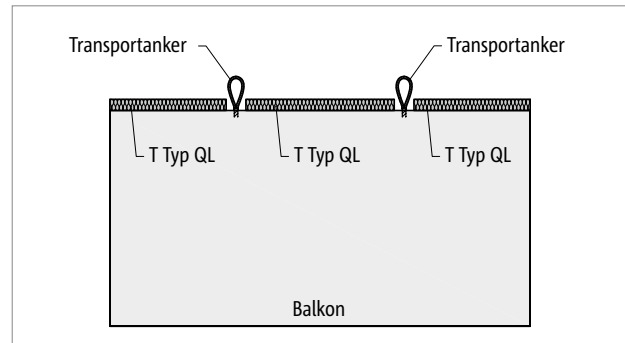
Schöck Isokorb® T Typ QL: Elementbalkon mit Transportanker; Dämmzwischenstück T Typ ZL kann bauseitig eingelegt werden
